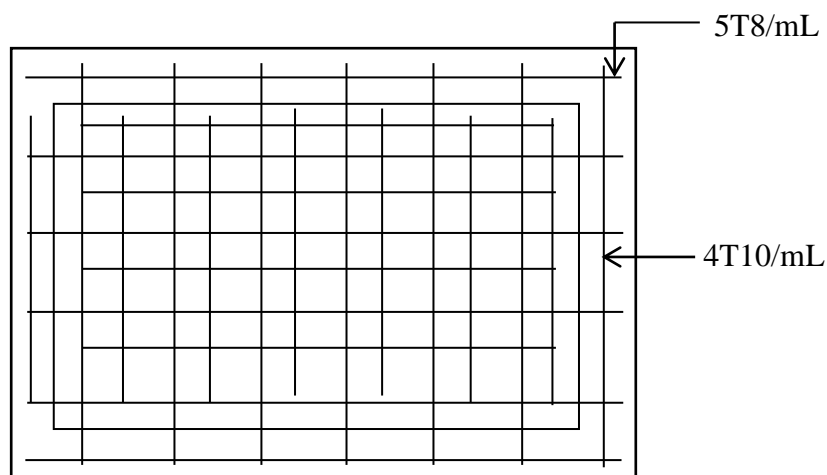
Ferrailage Inférieur du panneau de dalle.
